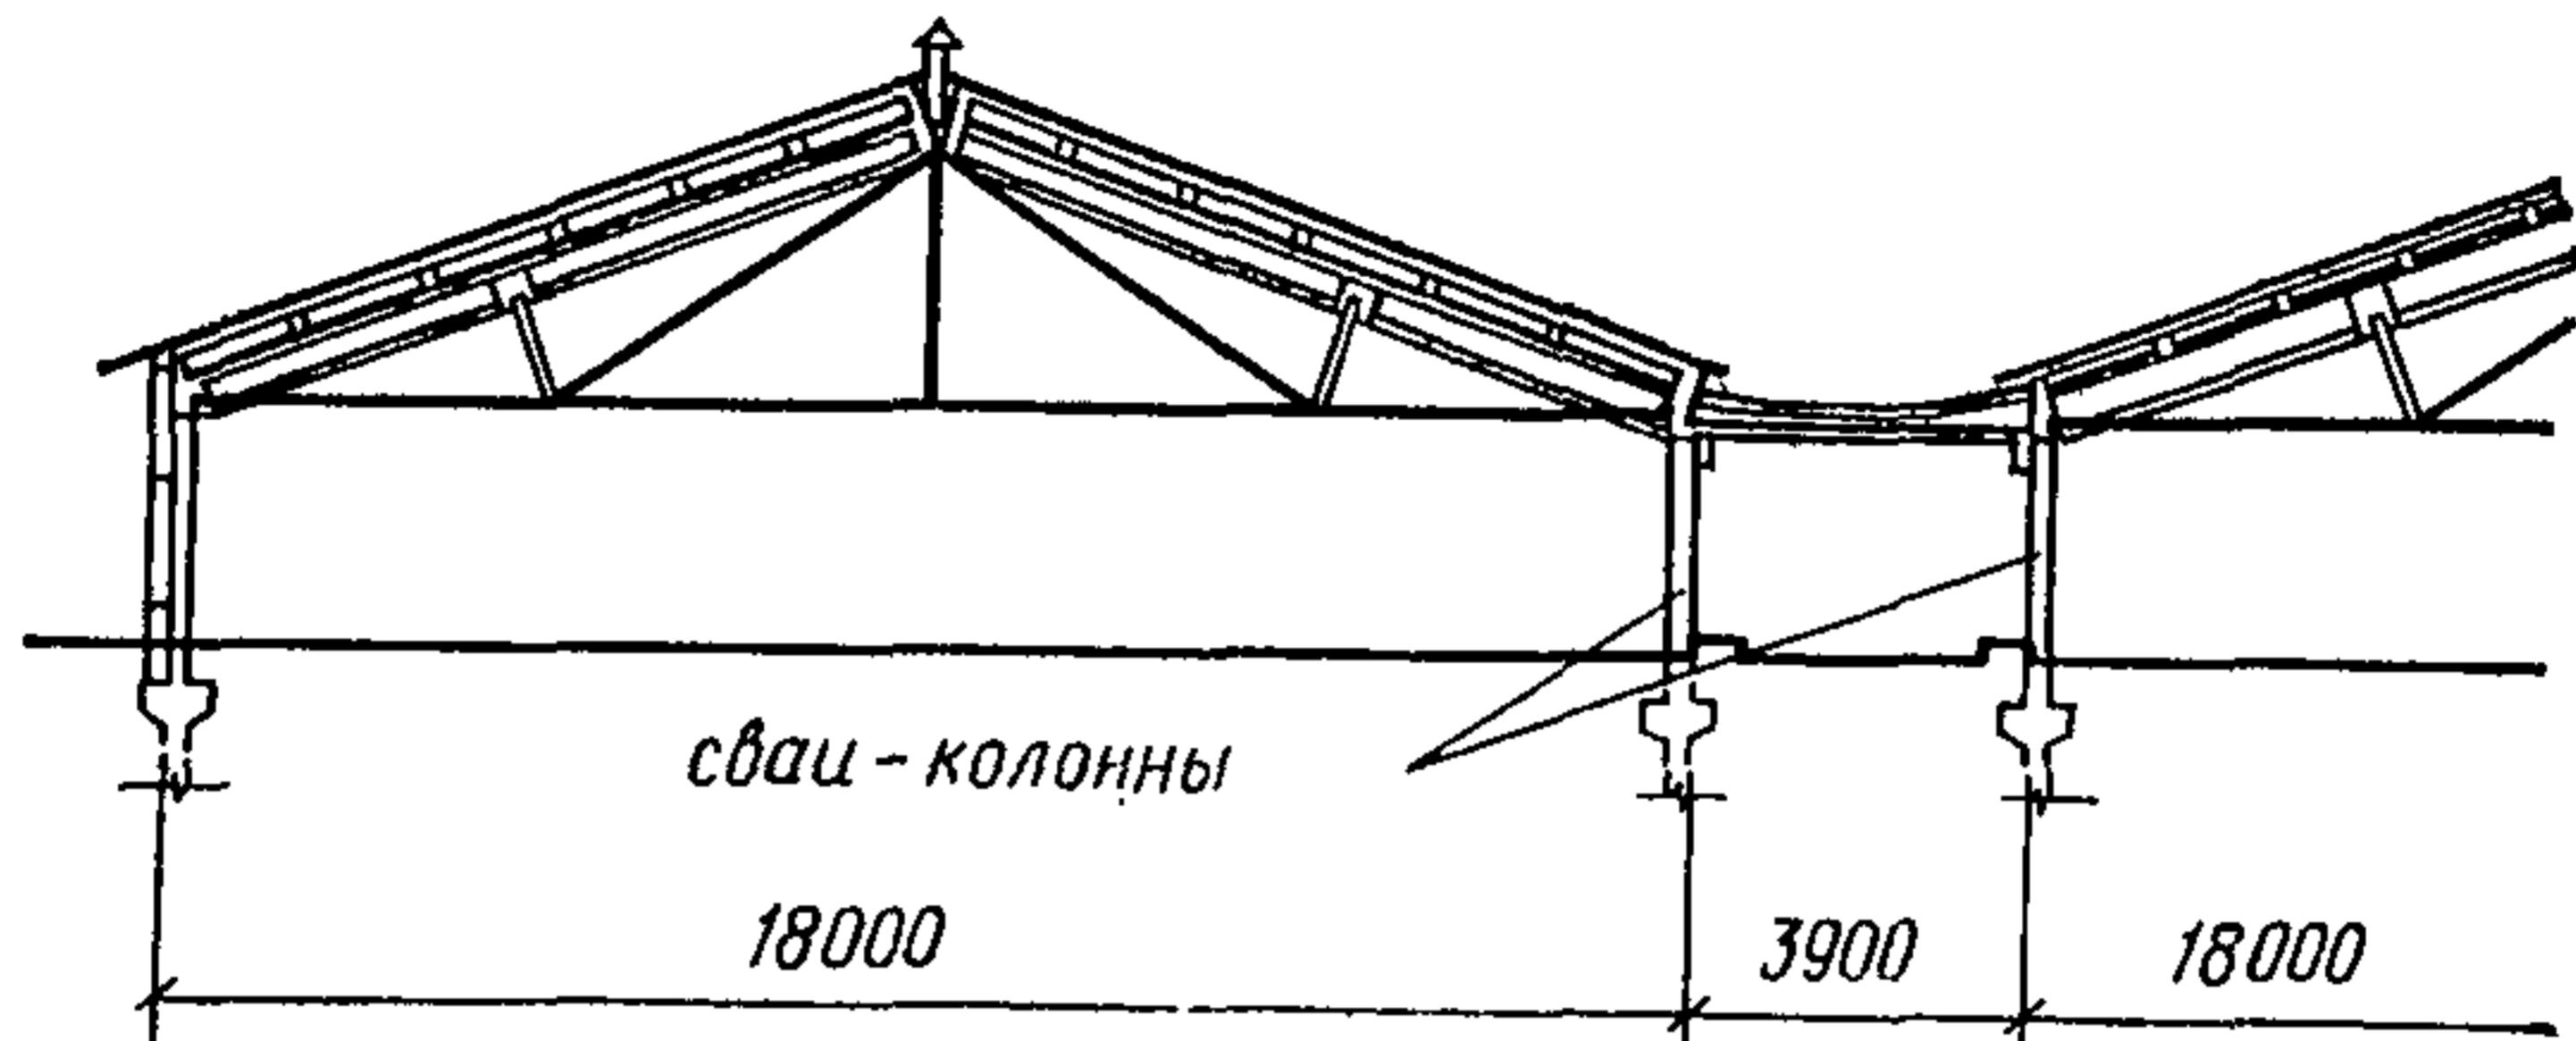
Фрагмент конструкций здания овчарни на 2500 овцематок
